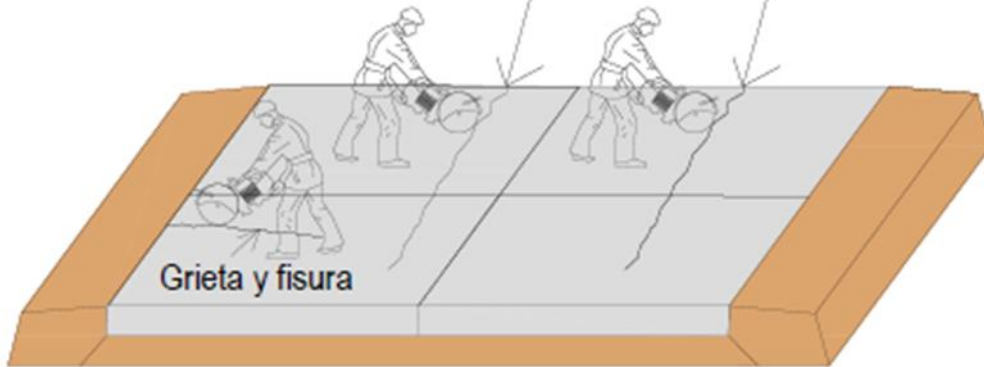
Sellado de Fisuras y Grietas, paso 1.
